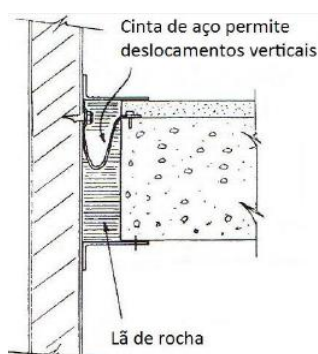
Sistema de ligação entre pavimento e parede (adaptado de [11]).
